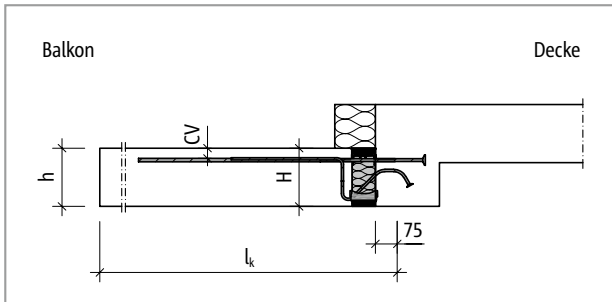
Schöck Isokorb® T Typ K-U: Statisches System
